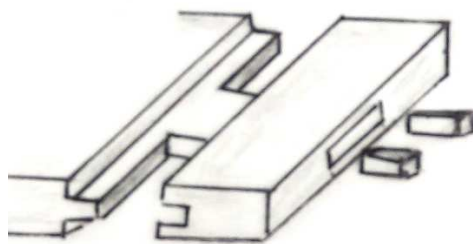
Detalle del ensamblaje de las piezas verticales con el peinado.
